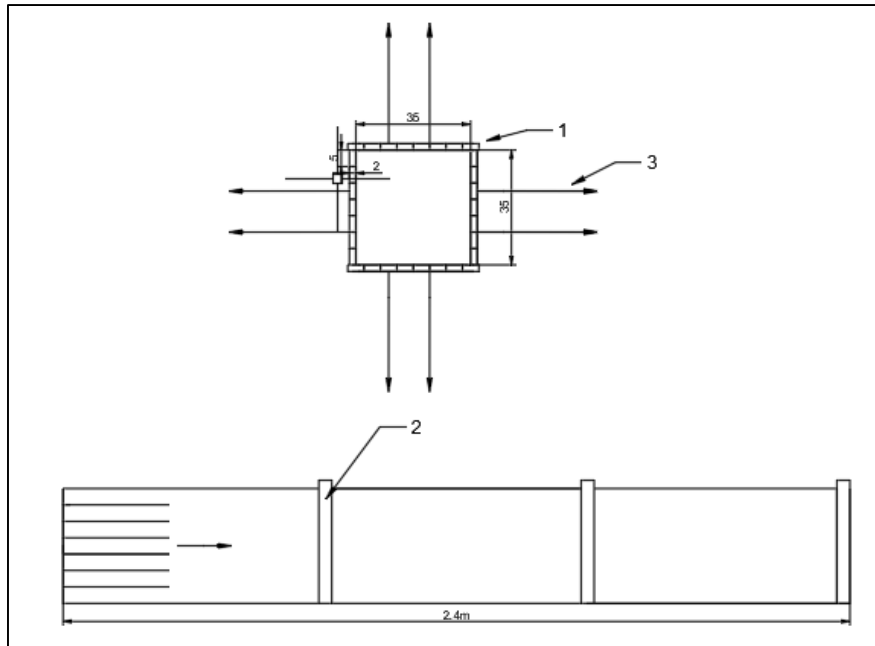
Detalle del encofrado para Columnas de 35x35 cm
